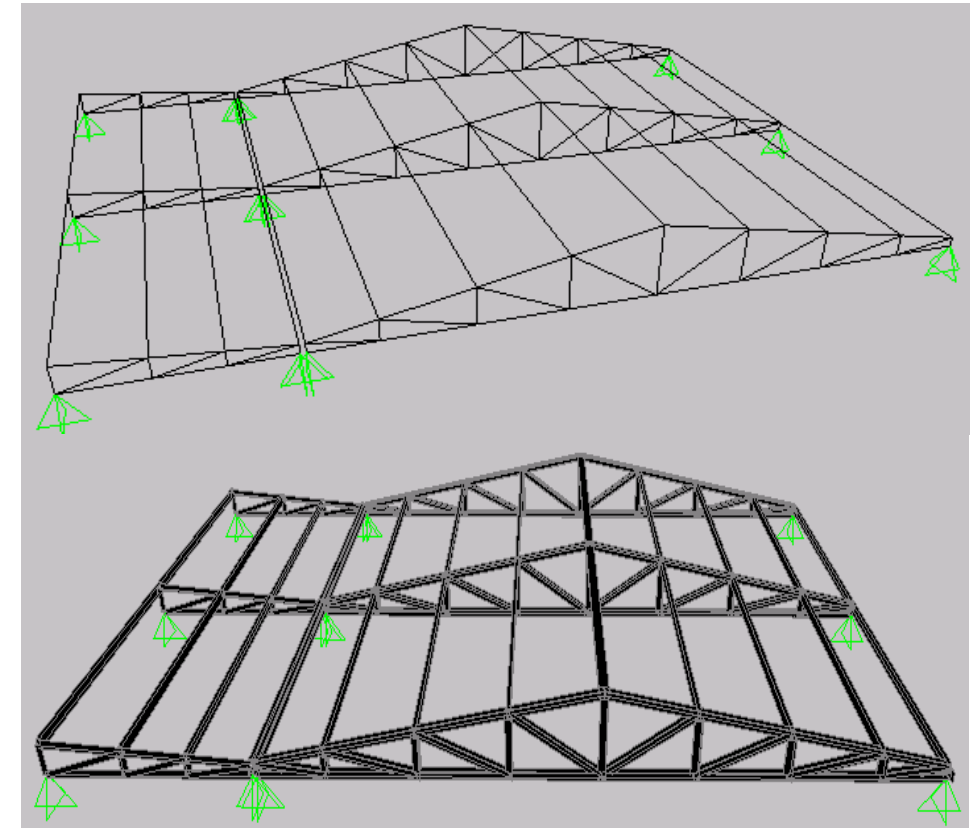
Vista general en planta e inferior de los ejes del bloque tres
